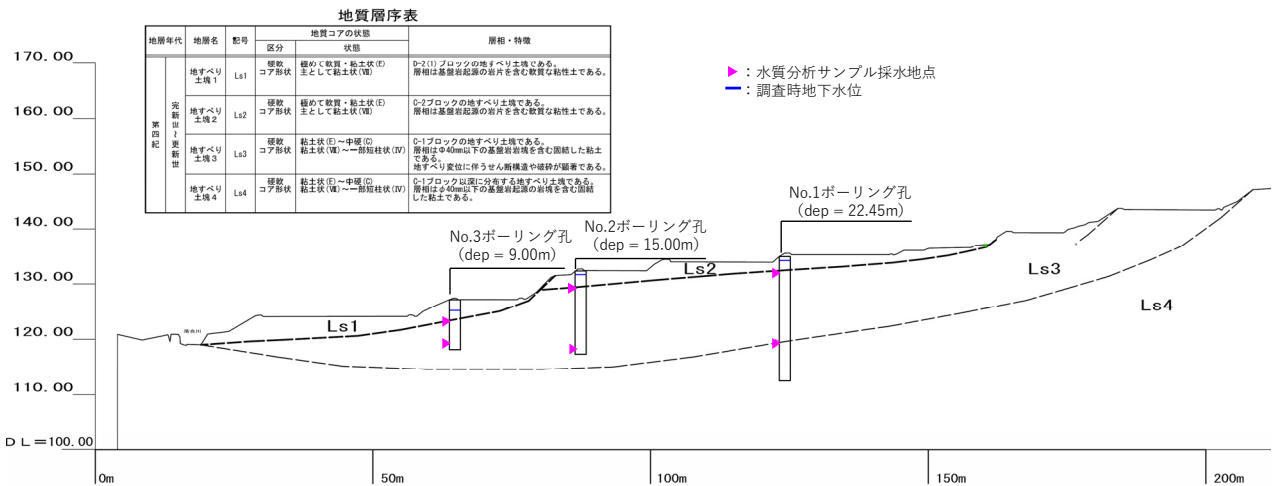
鈴倉地すべり C-2 ブロックと D-2(1)ブロックの断面図
